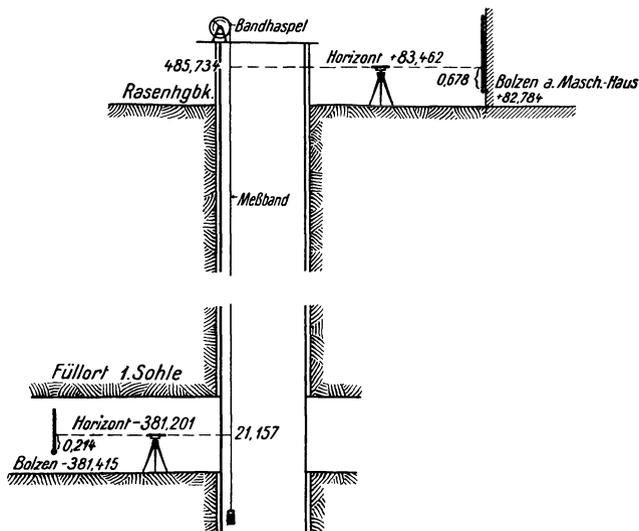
Teufenmessung mit dem Schachtmeßband.
